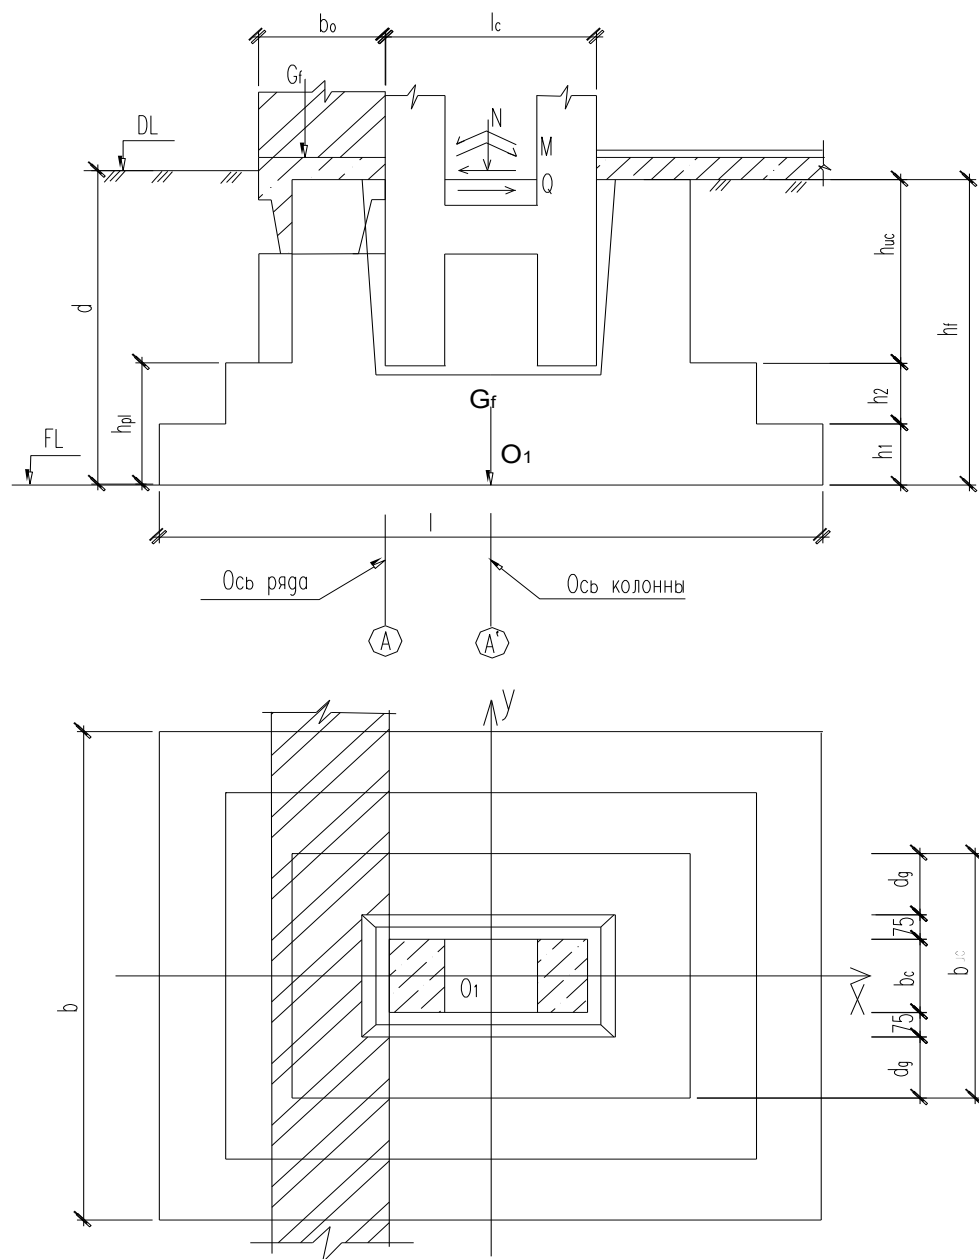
Схема проектируемого фундамента под крайнюю колонну цеха
